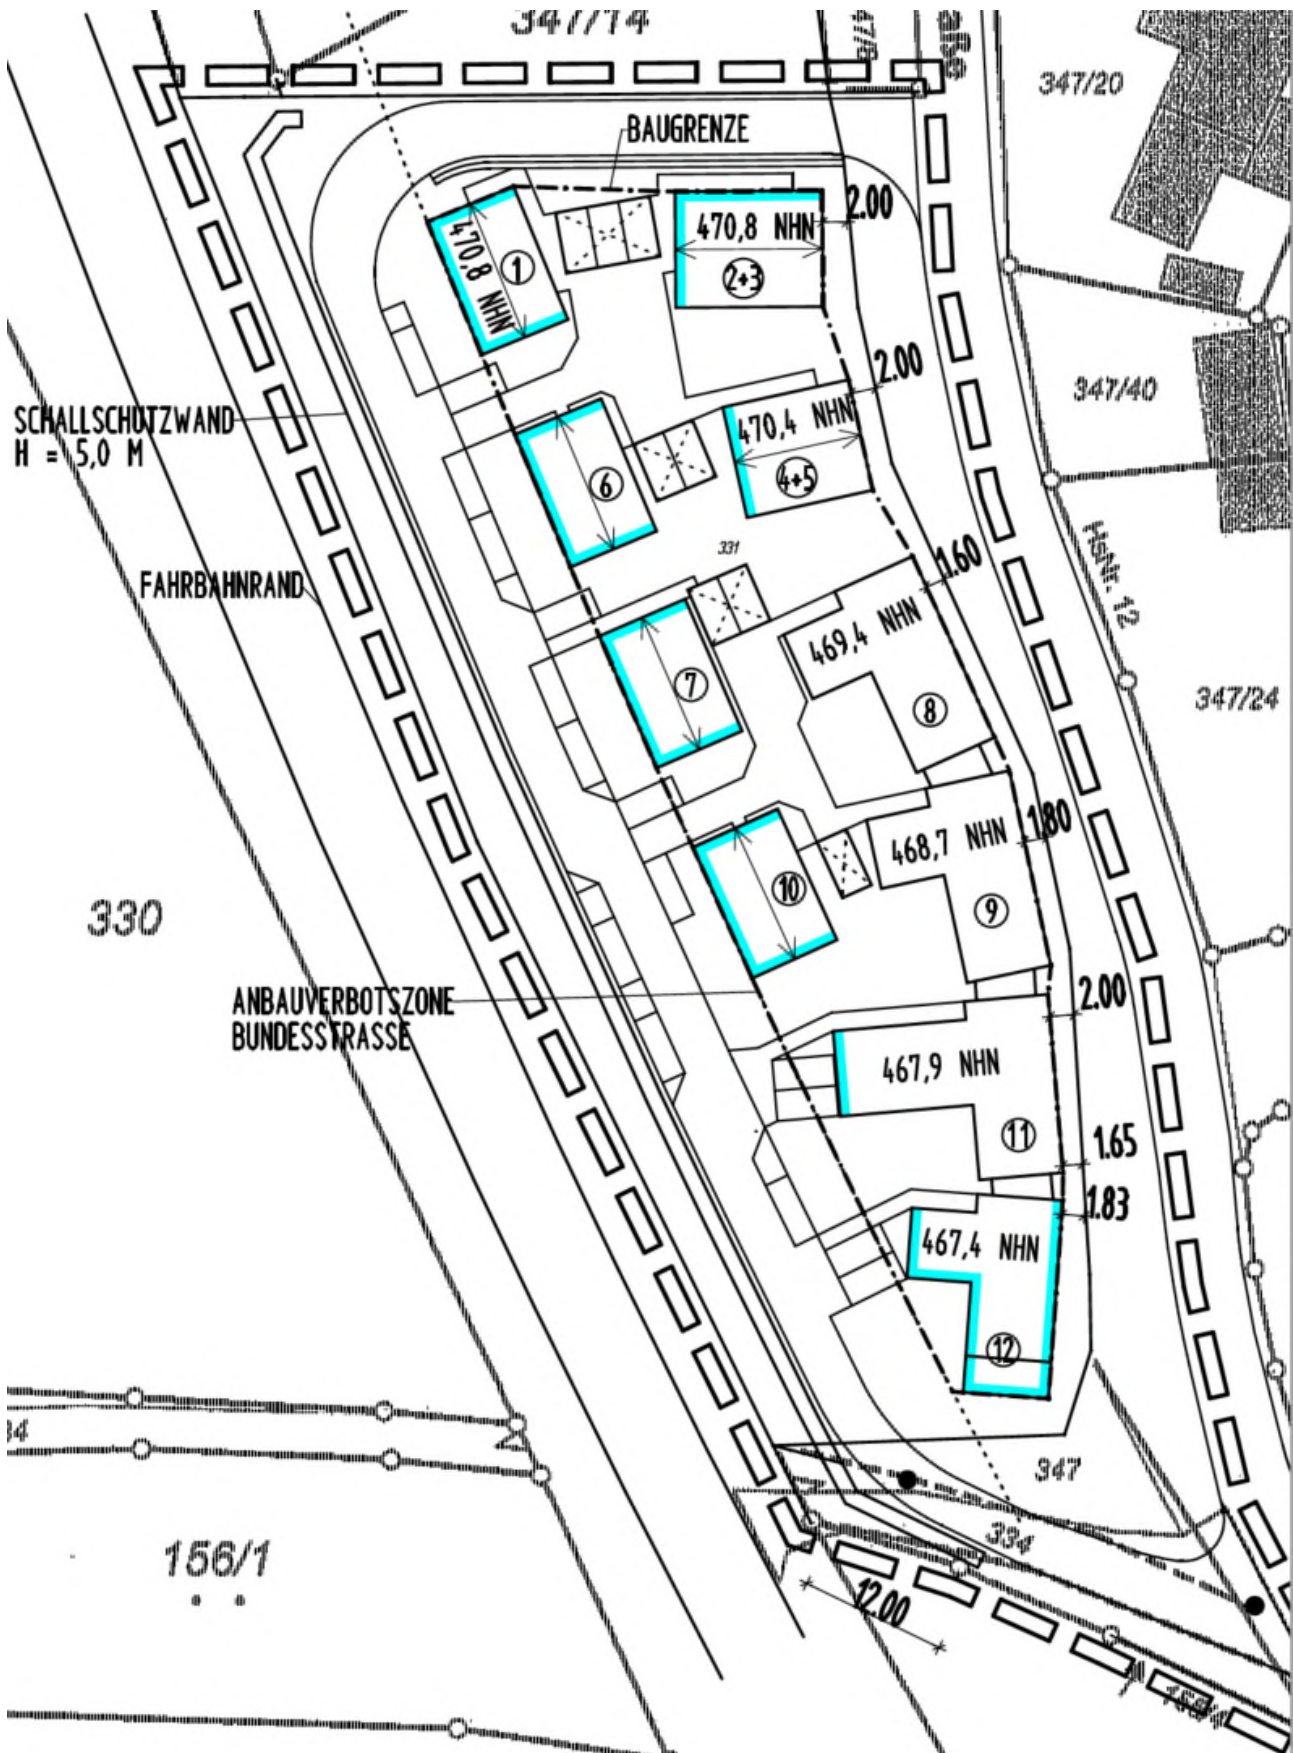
Auszug Lageplan mit Planbebauung, ohne Maßstab, Stand 14. Mai 2019
